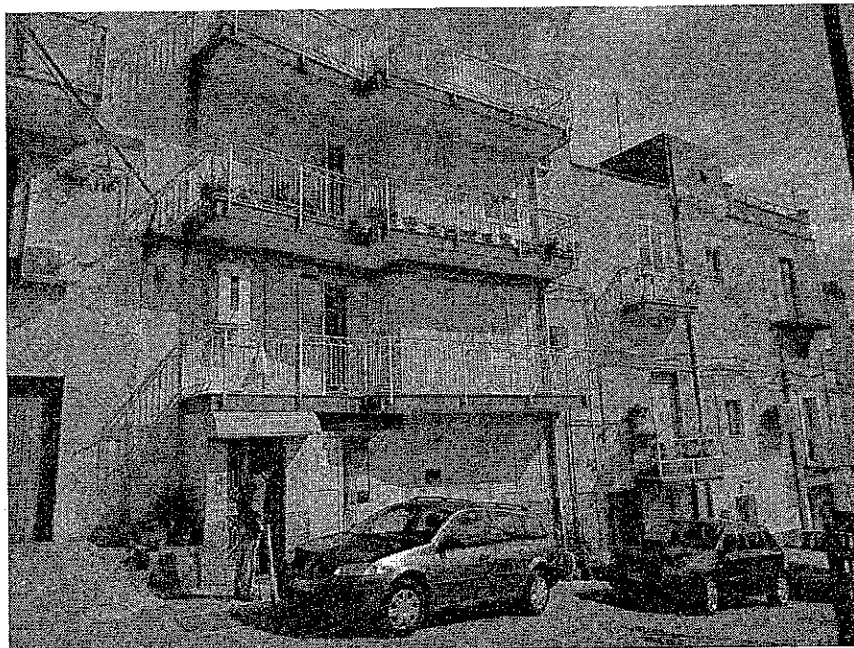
Prospetto dell'edificio con ripresa dal parcheggio di P.zza XXIV Maggio.
